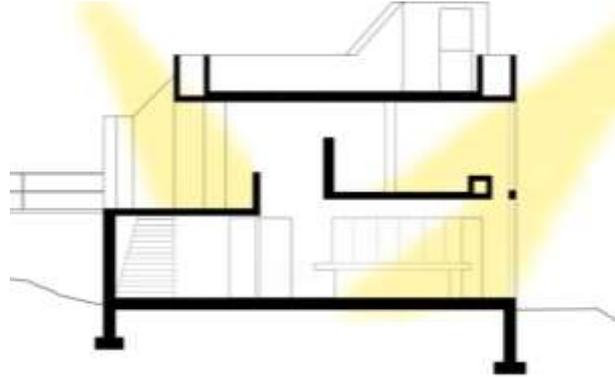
Sección del bloque de dos plantas de Creek Vean.
